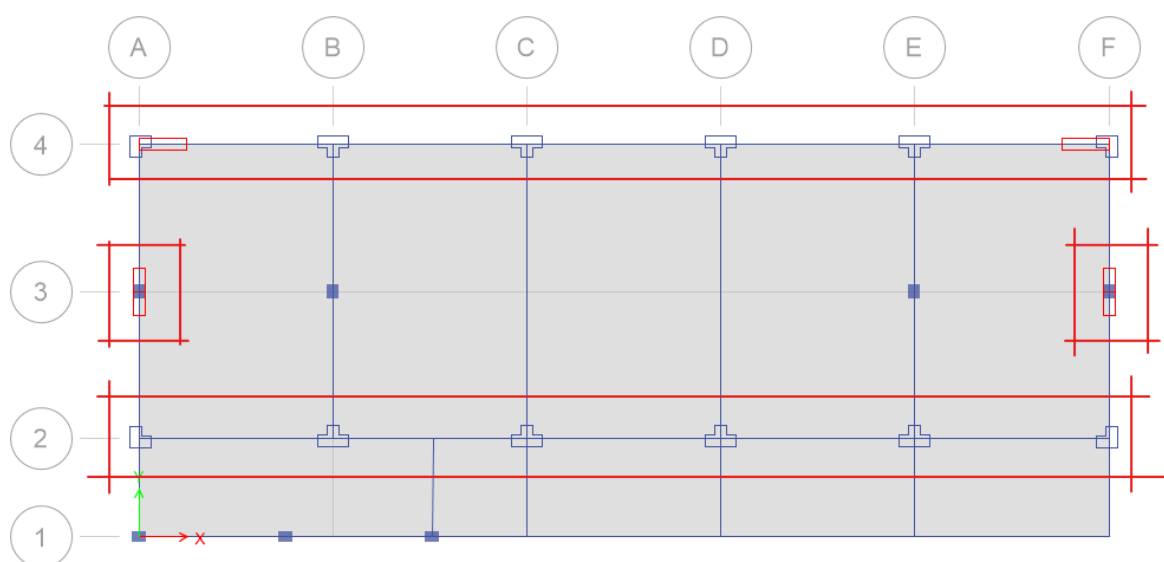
Vista en planta de los elementos estructurales reforzados. Fuente: Elaboración propia.
